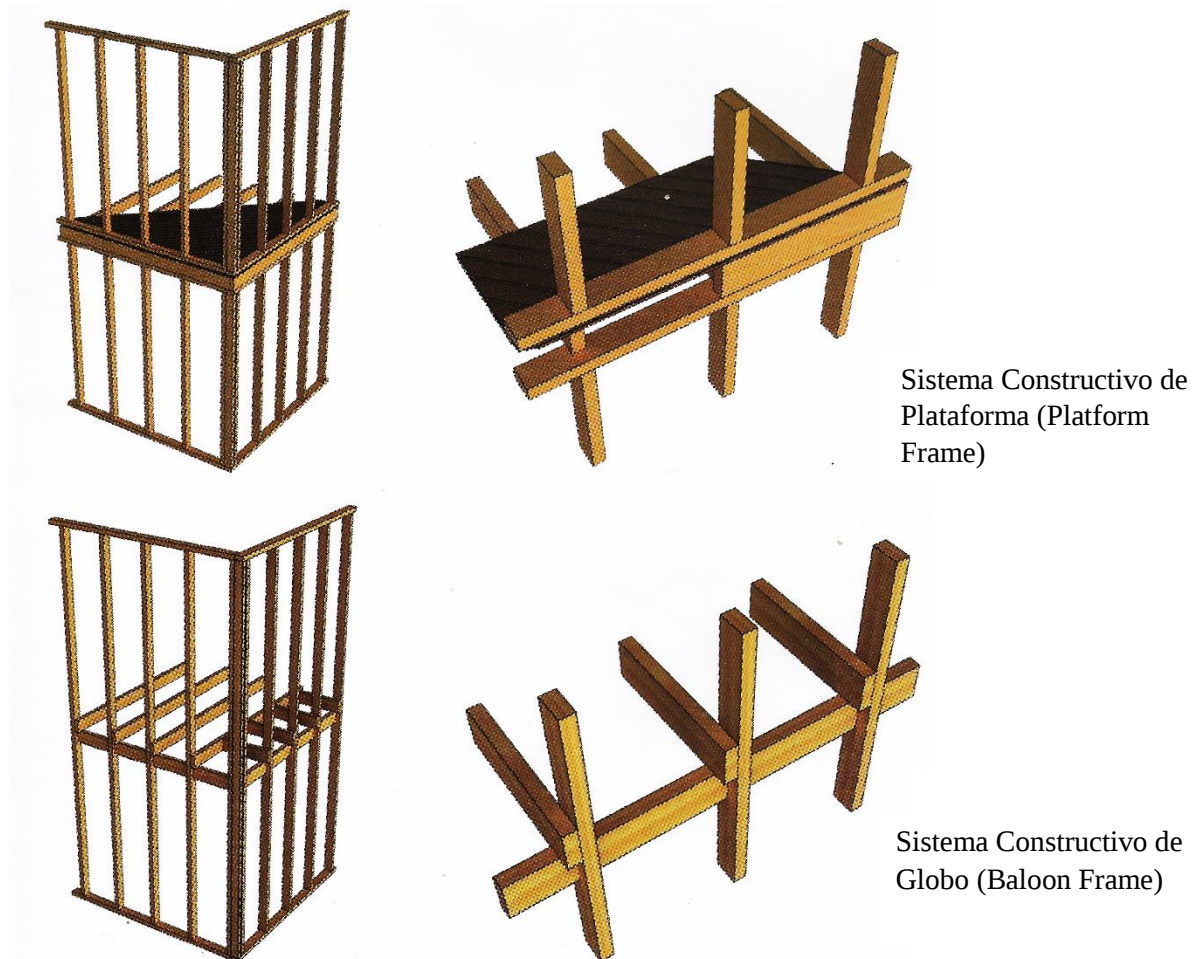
Sistema Constructivo Platform Frame y Baloon Frame. Entramados de Madera, Universidad del Bio Bio, Chile.
